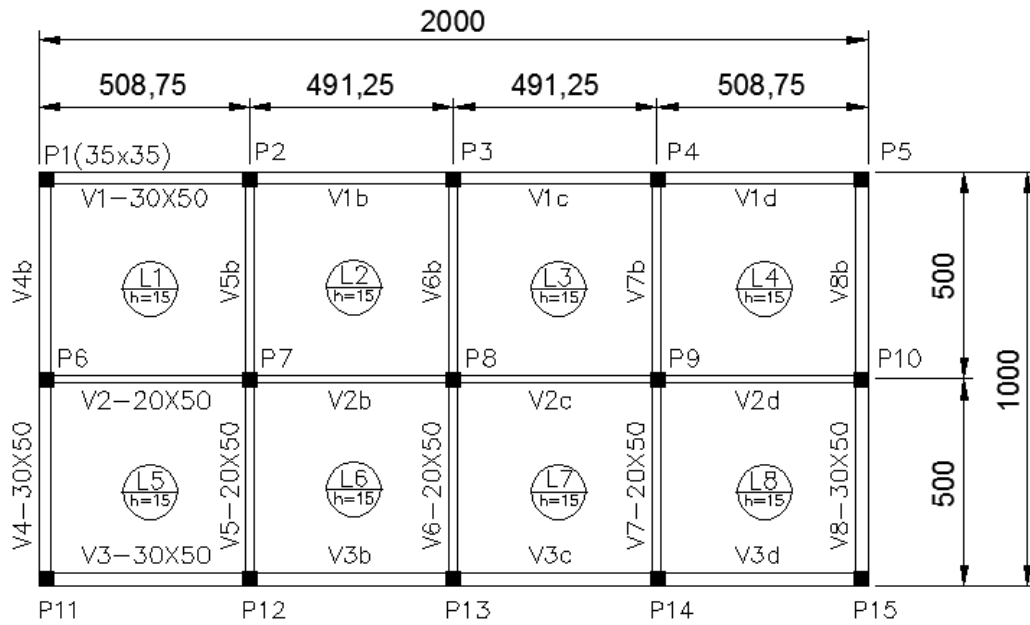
Planta de forma do Pavimento 1, sem escala, dimensões em cm.
